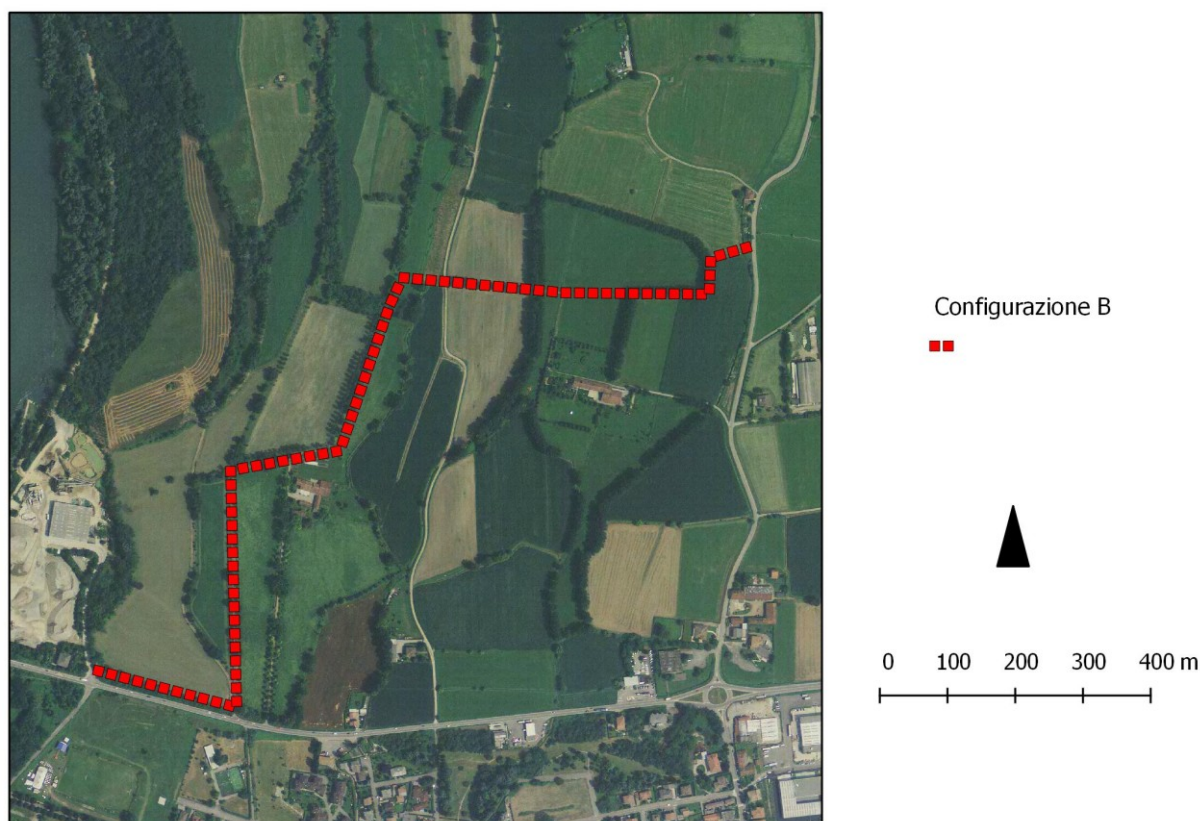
Planimetria del nuovo rilevato arginale sovrapposto alla foto aerea dell'area.
